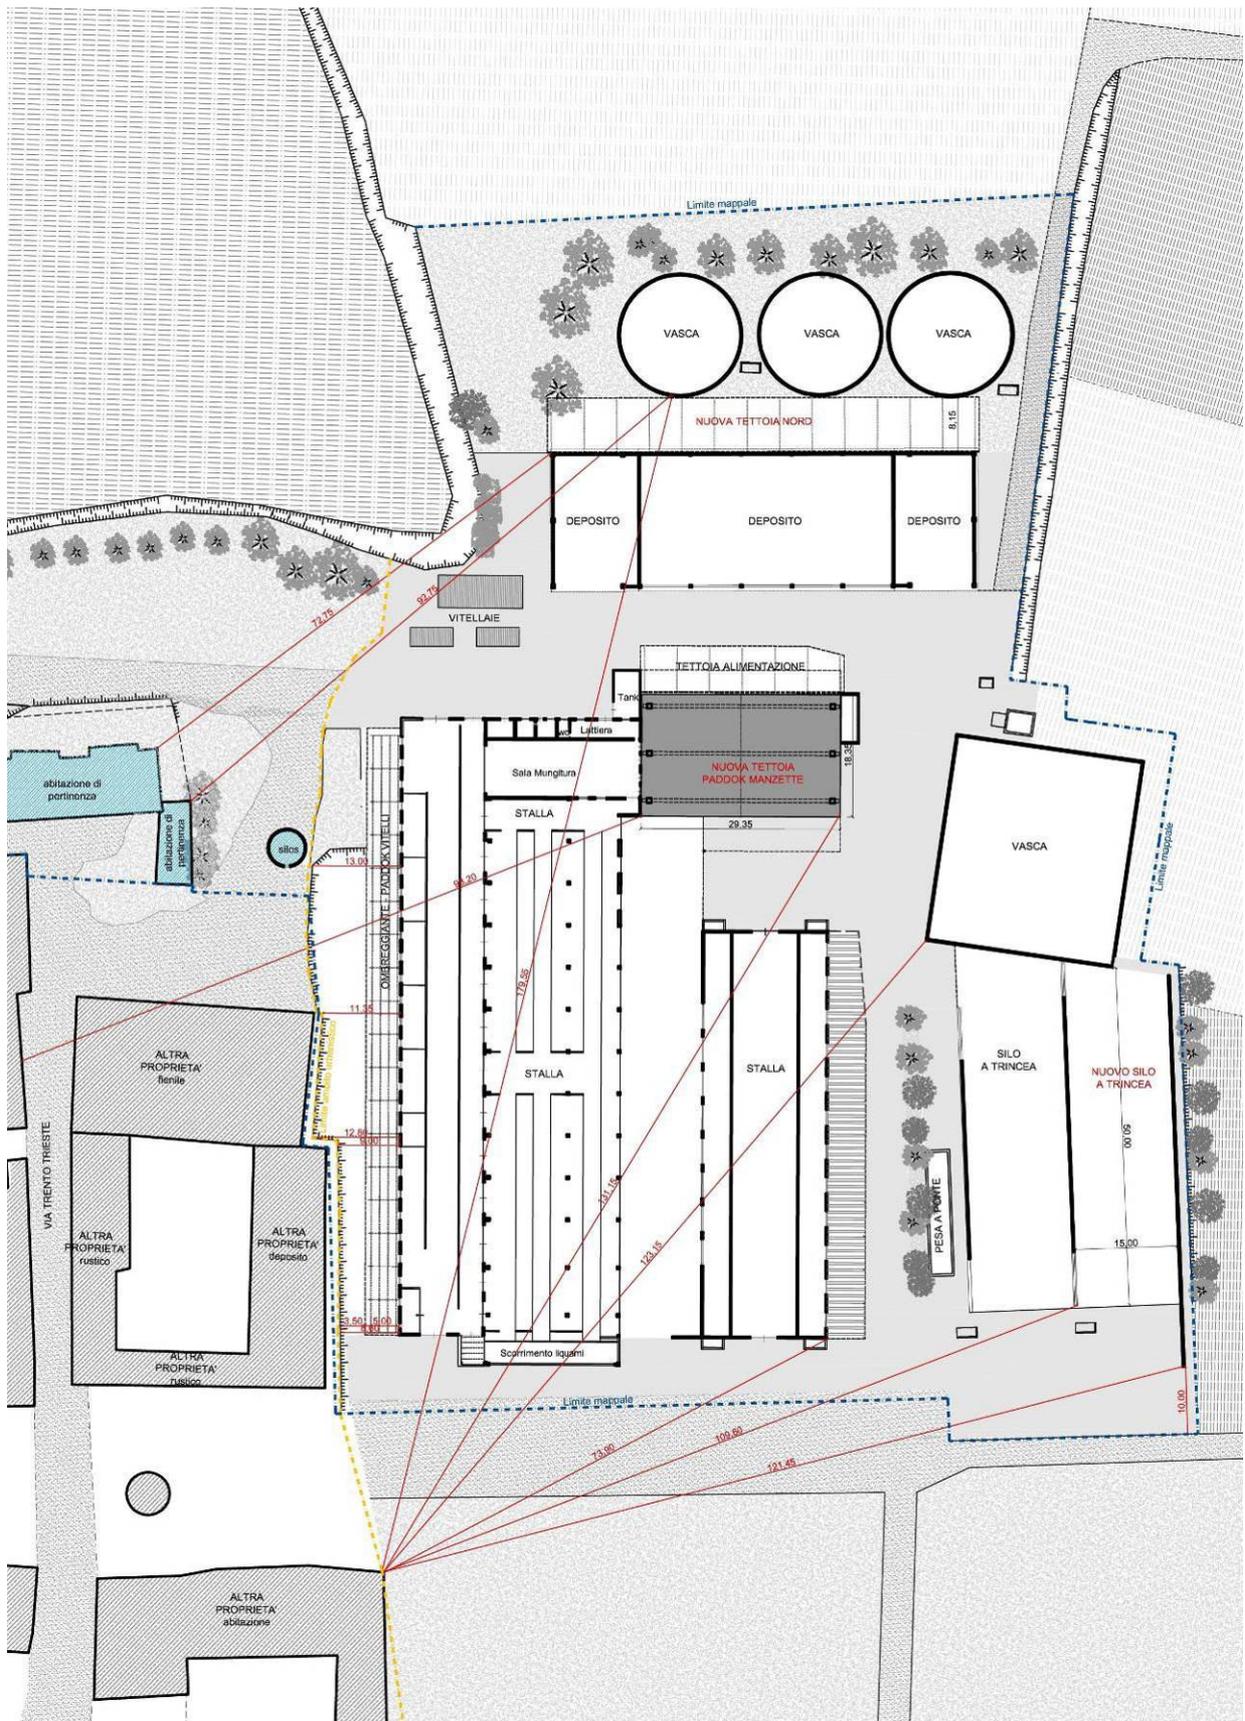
Estratto della planimetria generale dell'area di intervento allo stato di progetto
